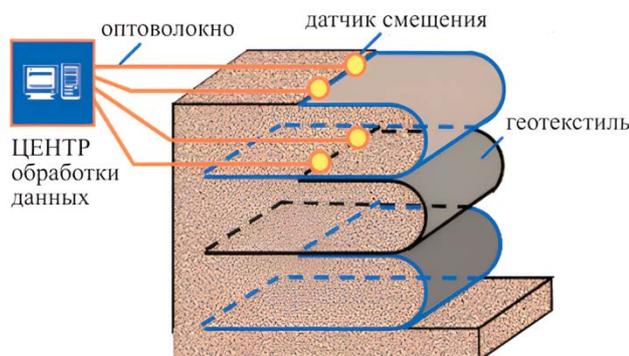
Схема армирования насыпи «умным» геотекстилем
